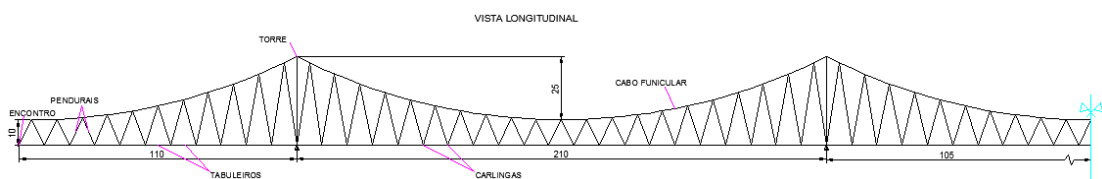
Vista longitudinal da ponte sobre o rio Save.
